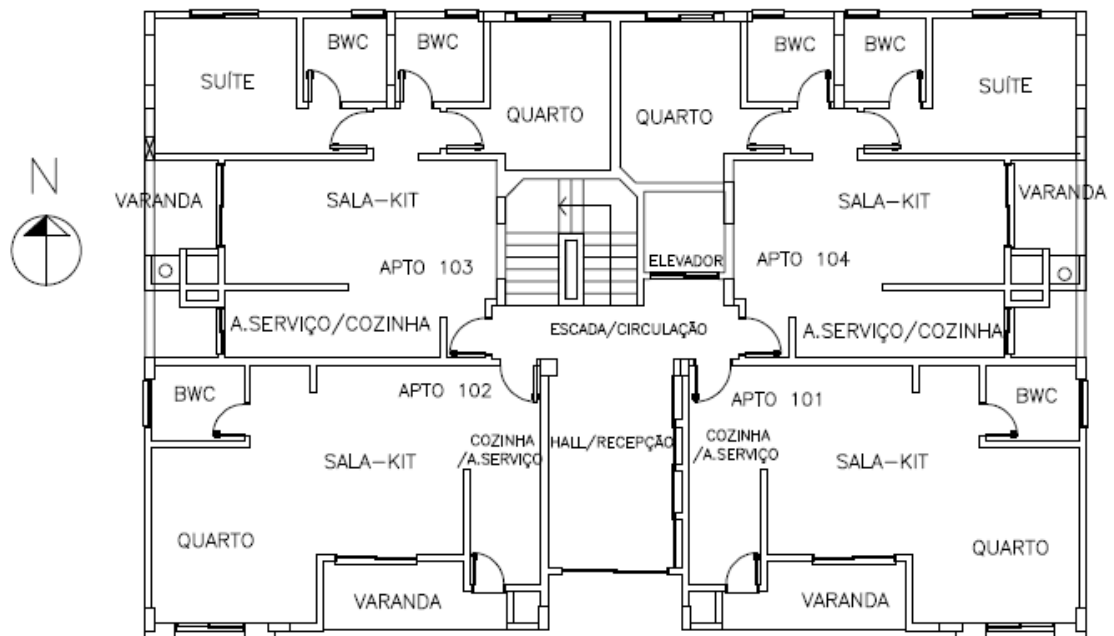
Planta baixa do segundo e terceiro pavimentos
